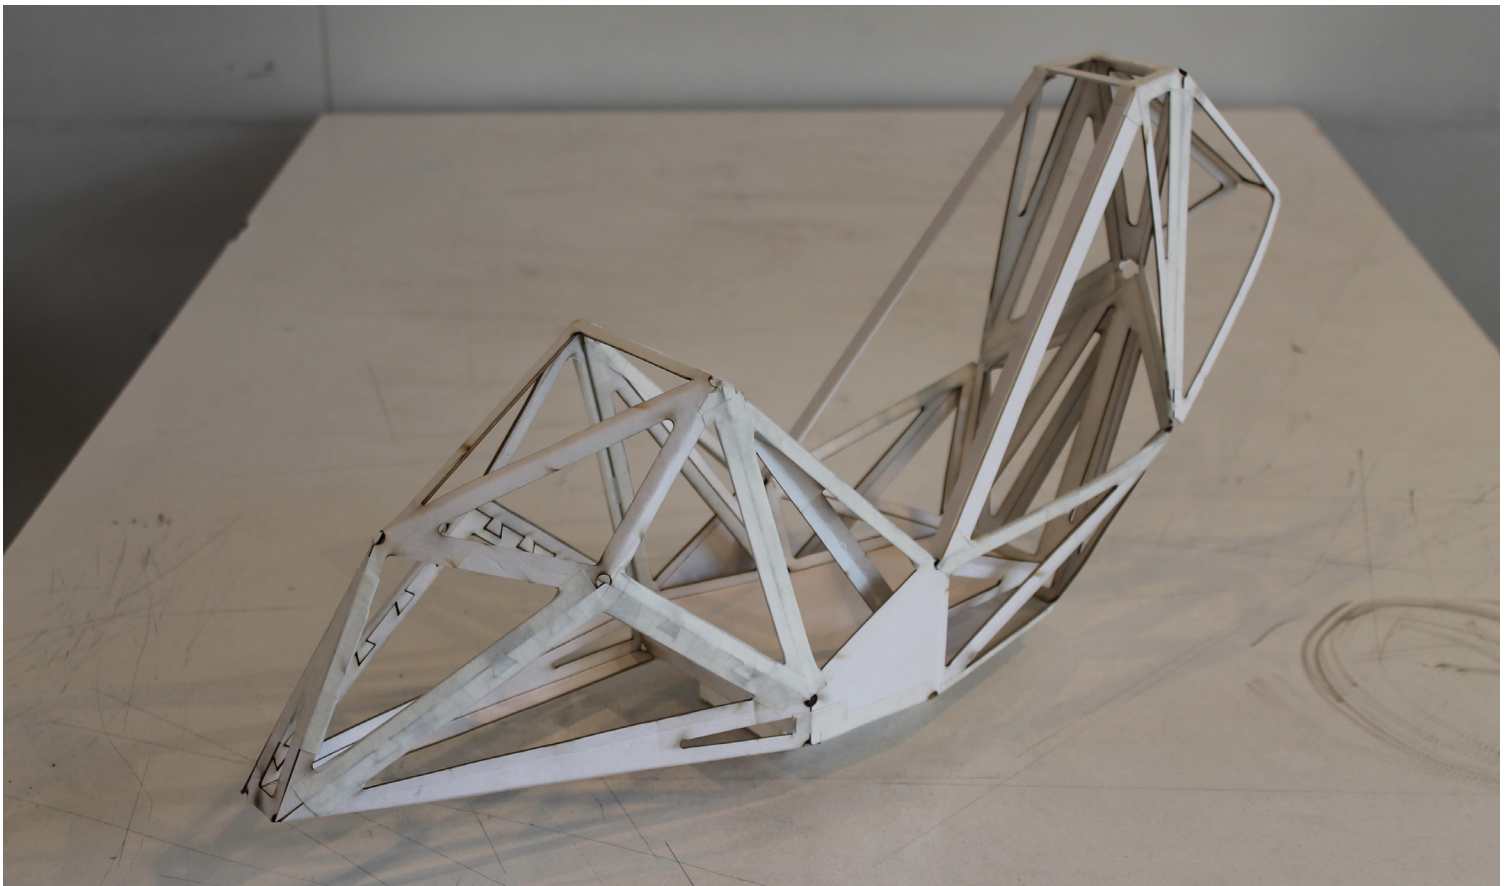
Maqueta de disposición de elementos estructurales facetada-vacía.
